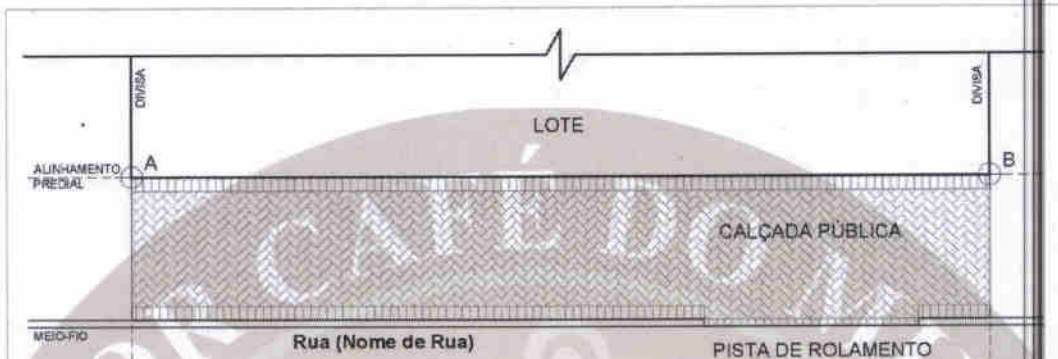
Planta esquemática para a definição da RN (sem escala)
